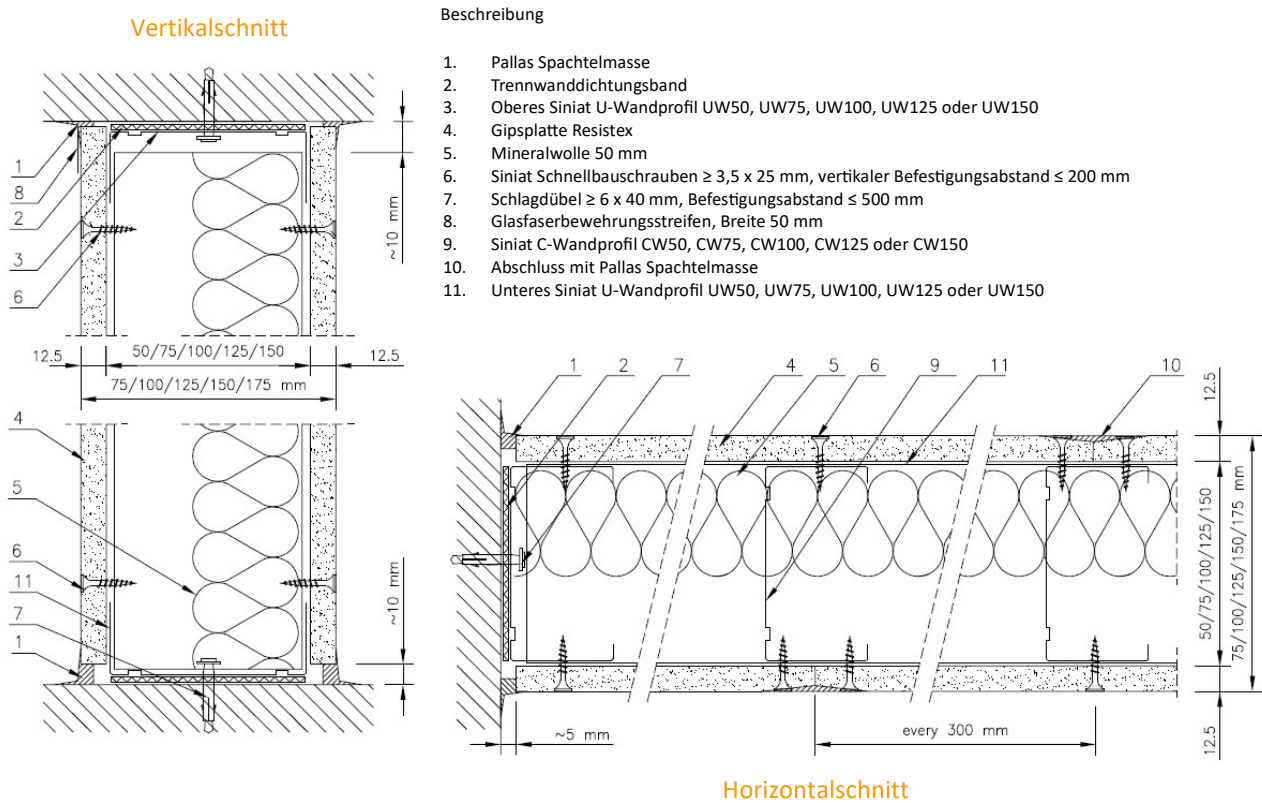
Vertikal- und Horizontalschnitt einbruchhemmender nichttragender einlagig beplankter Einfachständerwände
